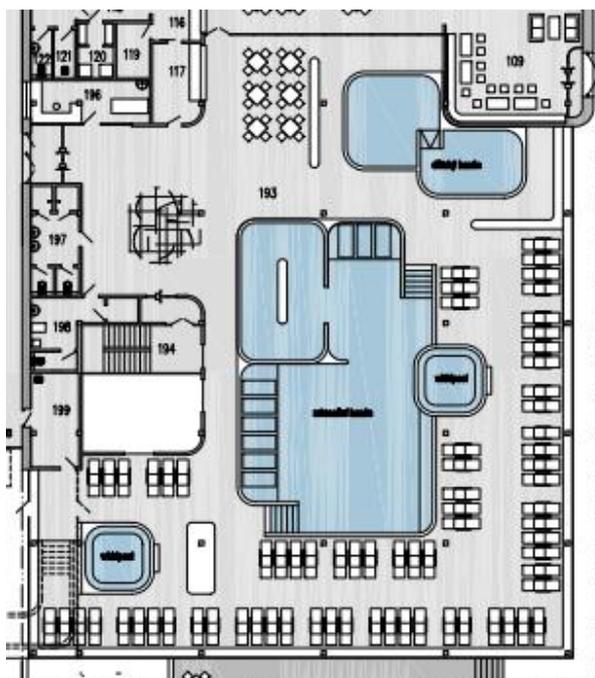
schéma funkčního řešení půdorysu 1.NP varianta 3
